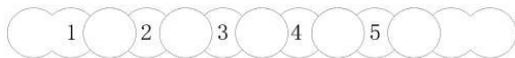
三轴搅拌桩施工方法的咬合式施工顺序示意图；
